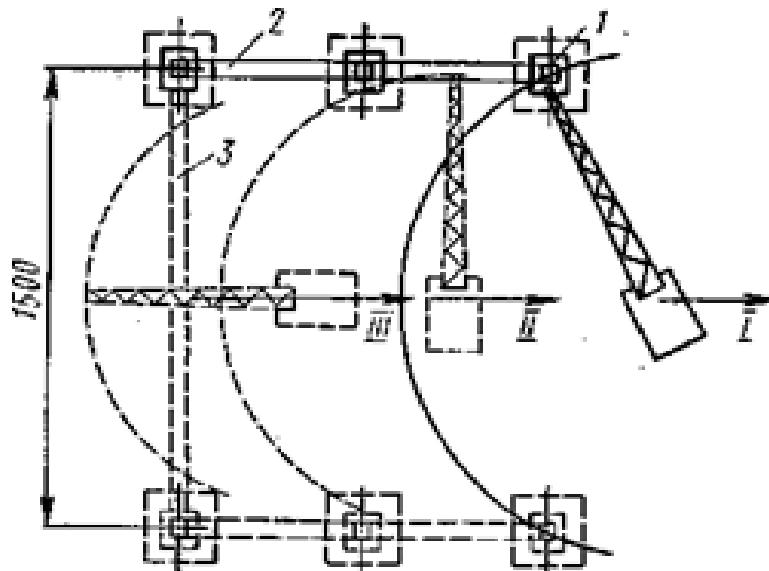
Схема монтажа сборных элементов каркаса одноэтажного промышленного здания раздельным способом
